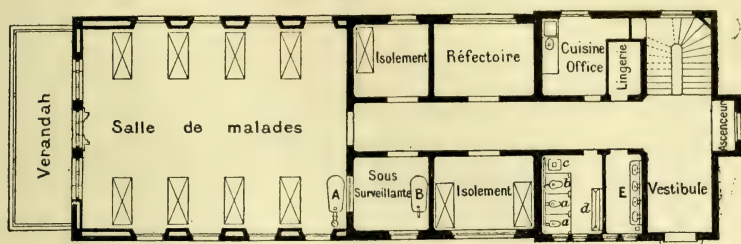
Plan d'un pavillon de l'hôpital Boucicaut.
